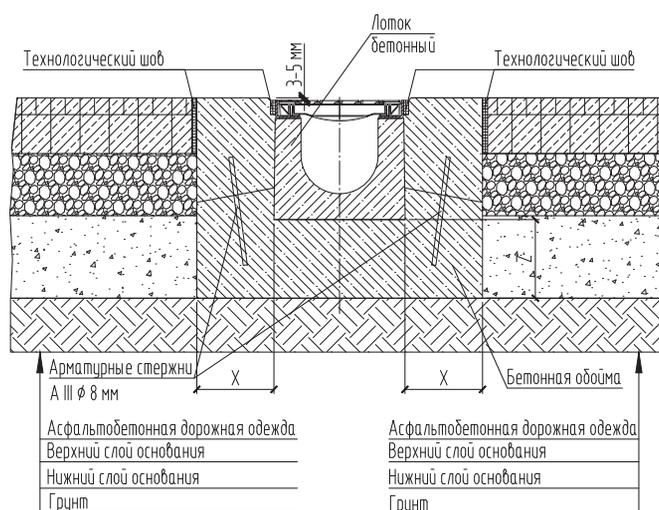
Пример обоймы бетонного лотка для класса нагрузки от D400 до E600 с прилегающим покрытием «асфальтобетонной дорожной одежды».
